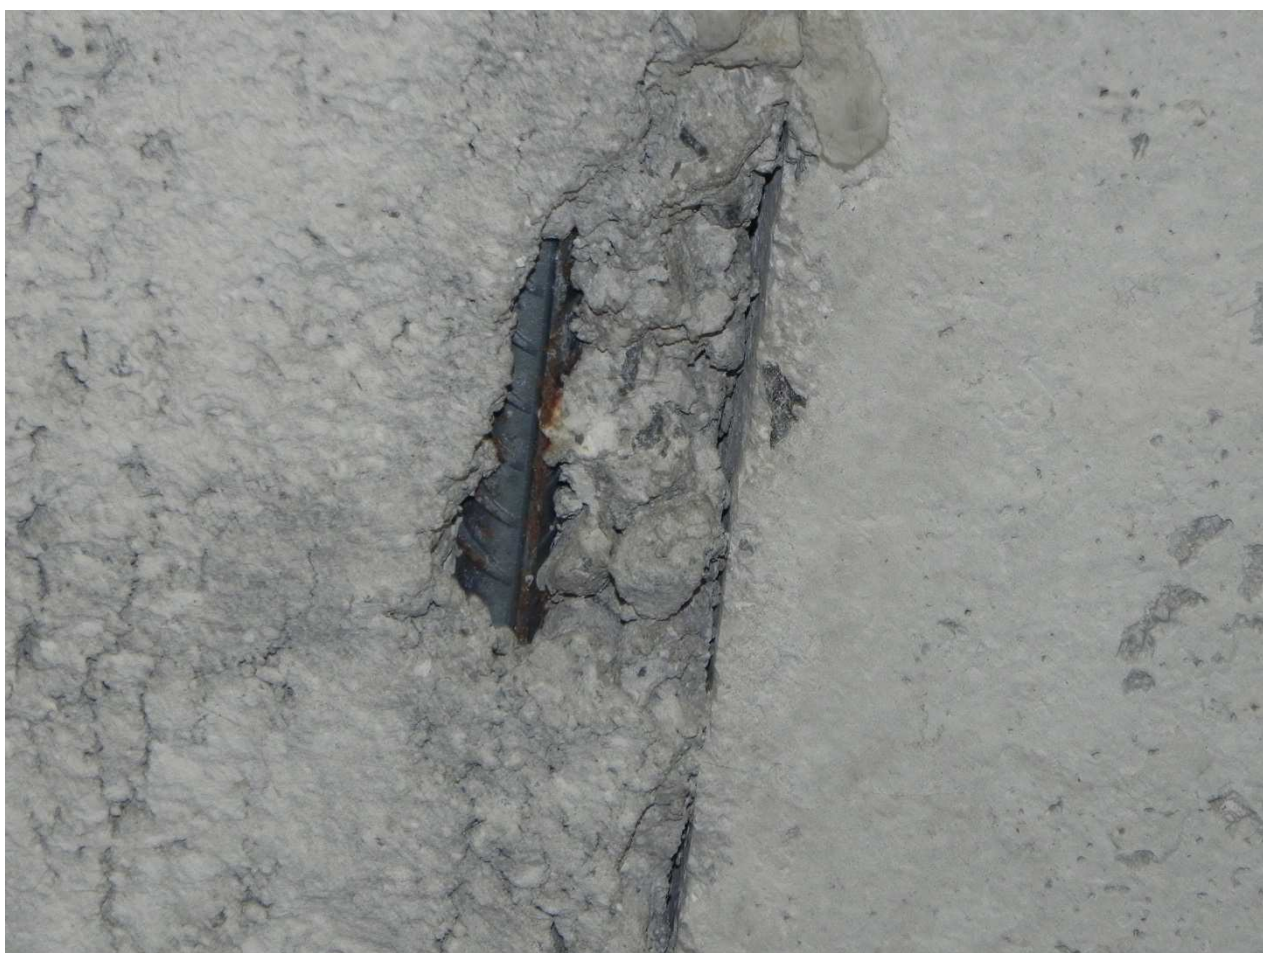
ŠPATNÝ STAV STROPNÍHO PANELU –V PANELU JSOU DÍRY
